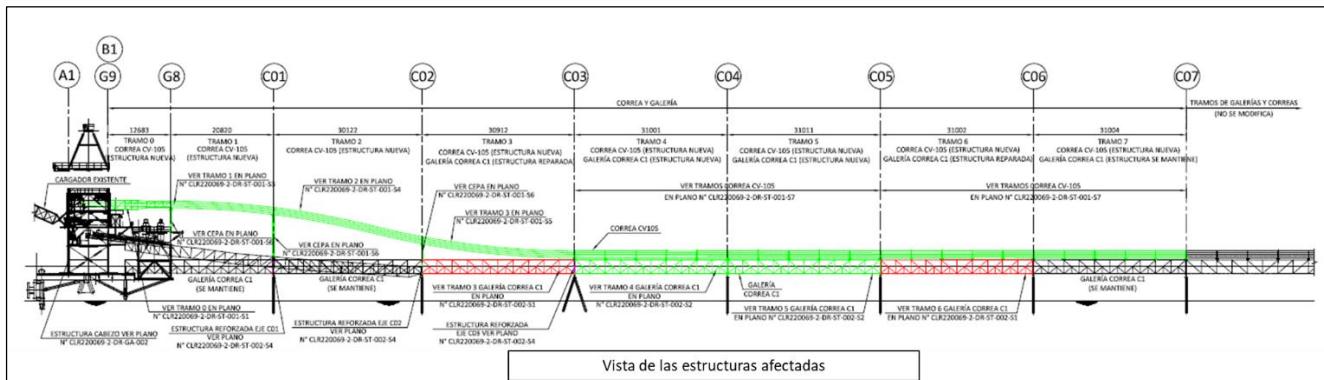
Vista del viaducto de acceso y sitio 1. Se observan correas CV-105 y galería metálica.
